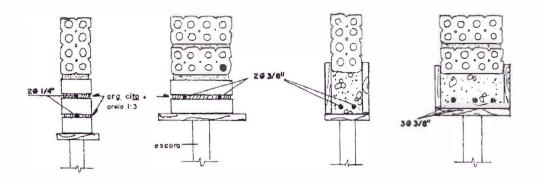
Vergas em alvenaria de tijolo furado para vãos até 1,00m e entre 1,00m e 2,00m
